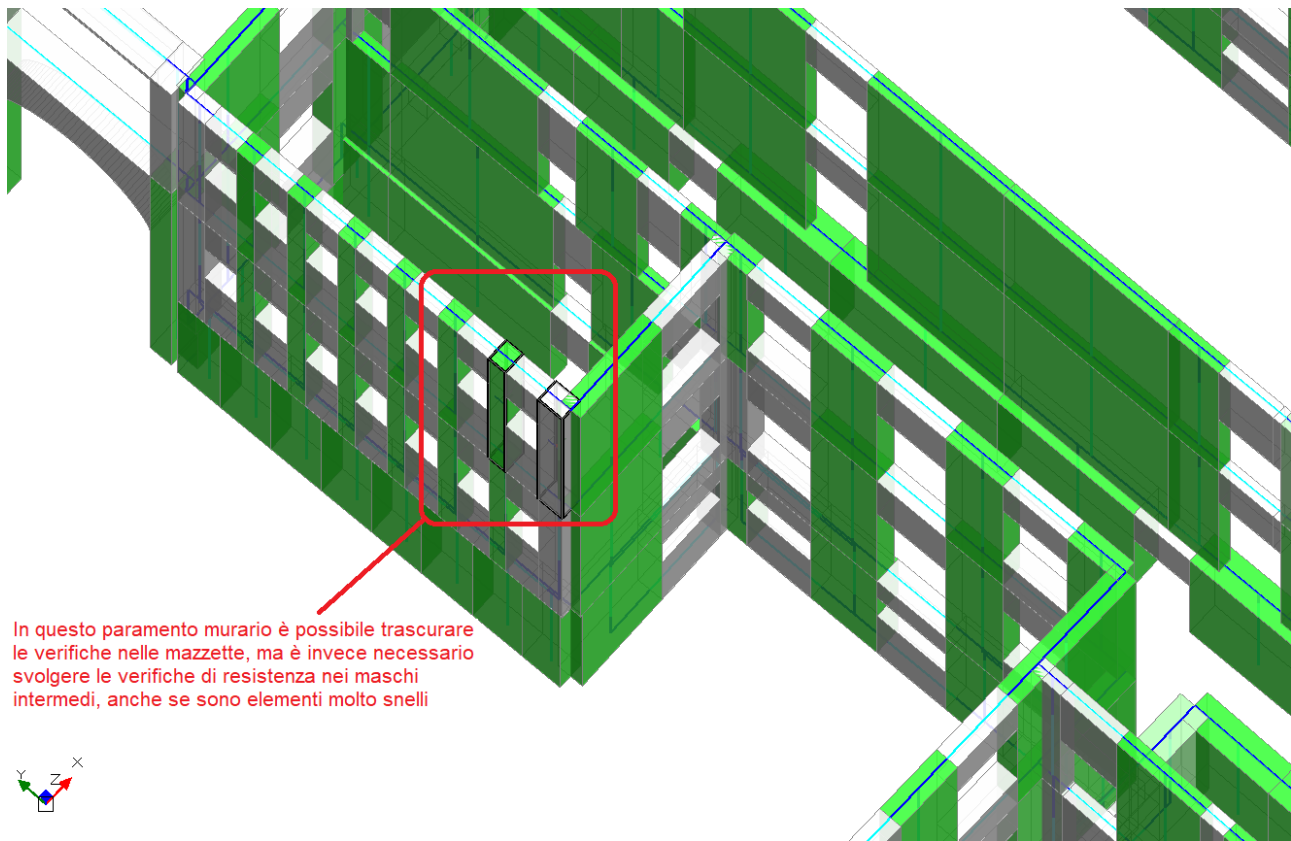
In uno stesso paramento, maschi con snellezza elevata possono avere o meno valenza strutturale rilevante, in dipendenza dalla loro posizione nella parete muraria
